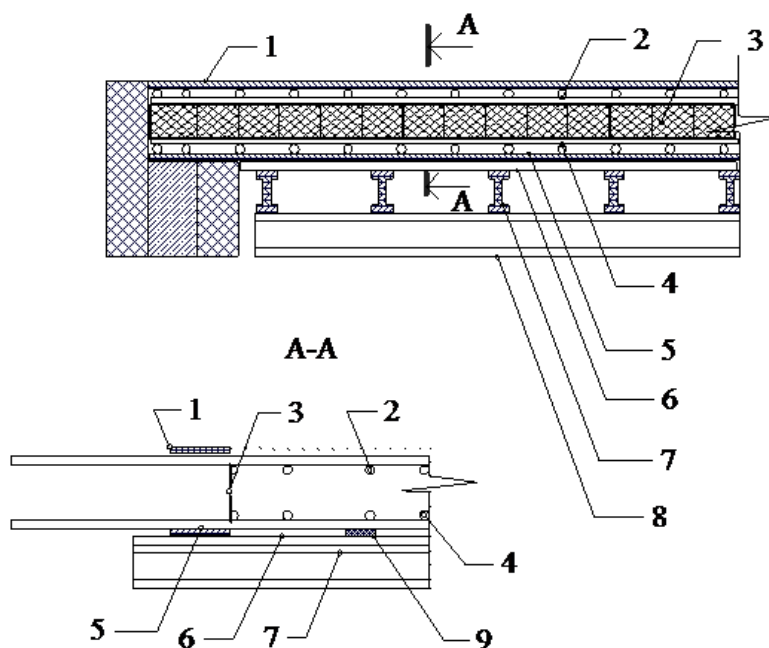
1.верхняя доска для формирования защитного слоя; 2.верхняя арматурная сетка; 3.сетка-рабца закрепленная на арматурный каркас; 4.нижняя арматурная сетка; 5.нижняя доска для формирования защитного слоя; 6.палуба (фанера); 7.поперечная балка; 8.продольная балка; 9.фиксатор арматуры
